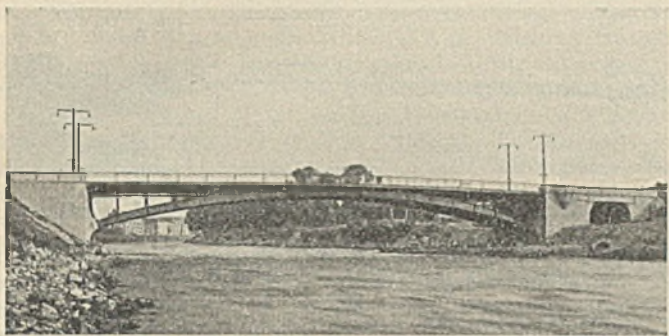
Schönau-Straßenbrücke über die Mur in Graz.
